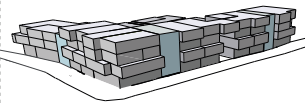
Módulos de Vivienda y movimiento en la fachada frontal
